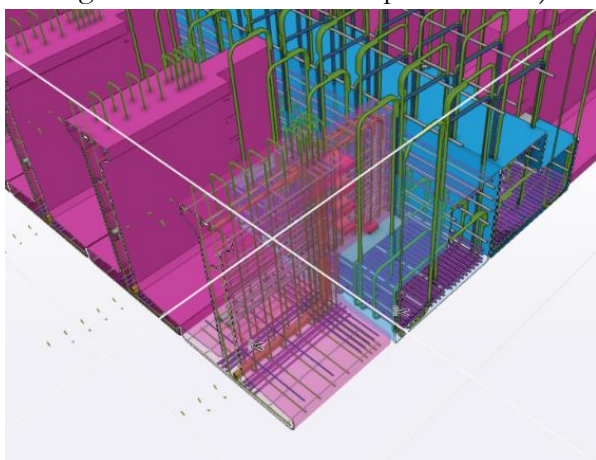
Modelo BIM. Comprobación de interferencias de armaduras en el prefabricado.
